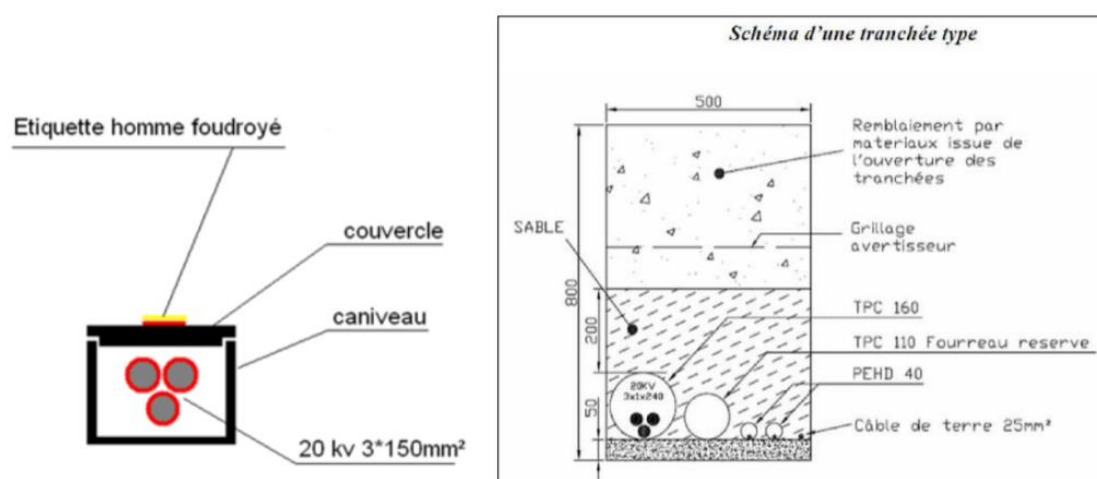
Schéma d'un caniveau pour câbles HTA (à gauche) et d'une tranchée enterrée (à droite)
